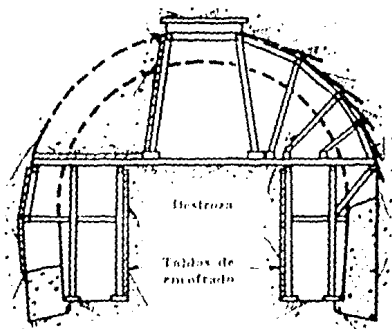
SECCION DE UN TUNEL ATACADO CON TRES GALERIAS.
